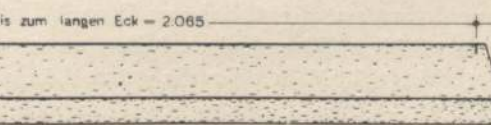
Kantholz zu einem ganzen Hauptdachsparren des Walmdaches in Abb. 1102, auf dem die Neigungslänge 2,065 m (ermittelt in Abb. 1107) vorgemacht ist.
